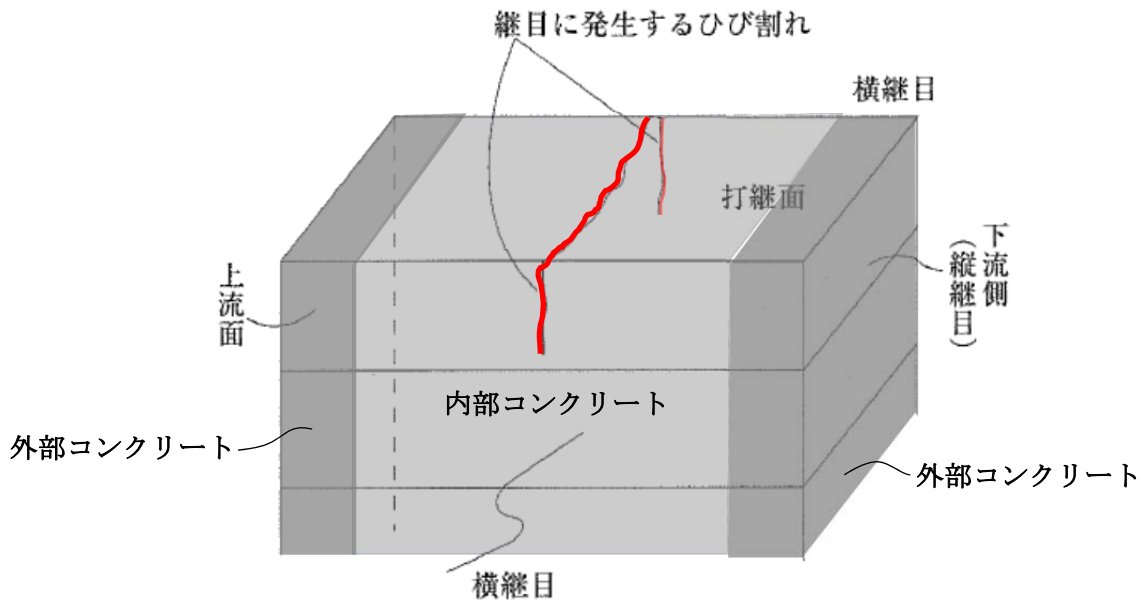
水平打継目に発生するひび割れの例³⁾
